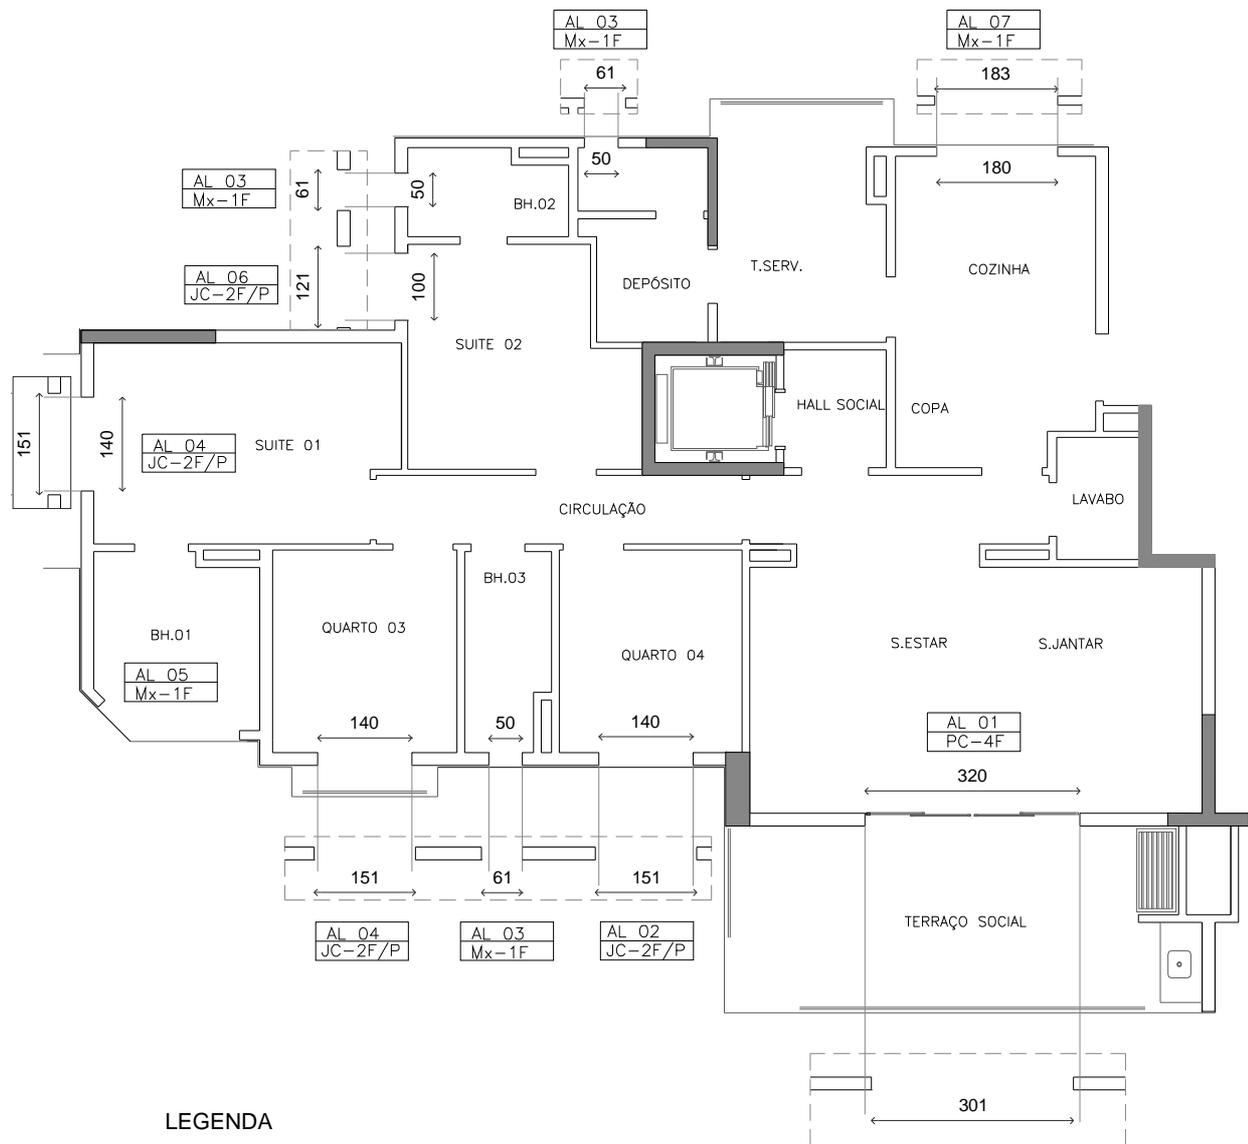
Planta A - apartamento 4 por andar - utilização dos caixilhos do catálogo
